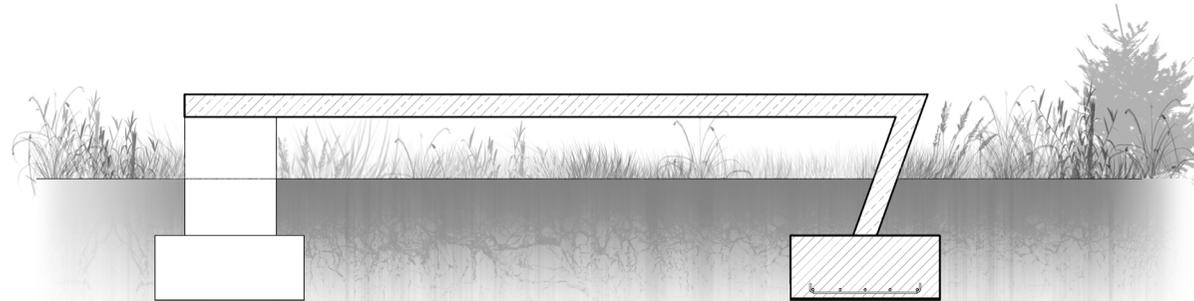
Banco doblado con 2 pilares – secciones
